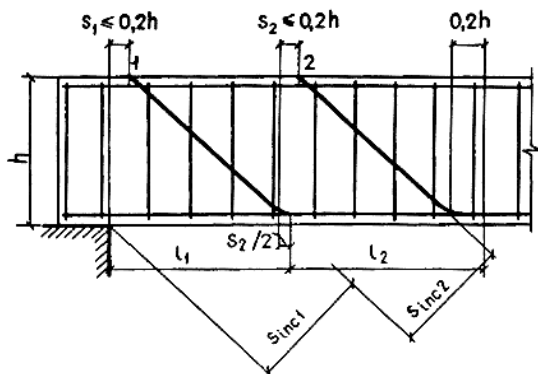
Учет отогнутых стержней при расчете наклонных сечений на выносливость
